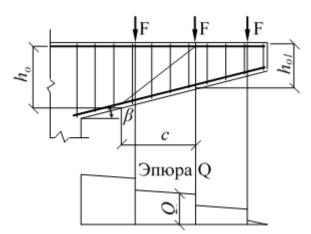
Наклонное сечение консоли с переменной высотой сечения
